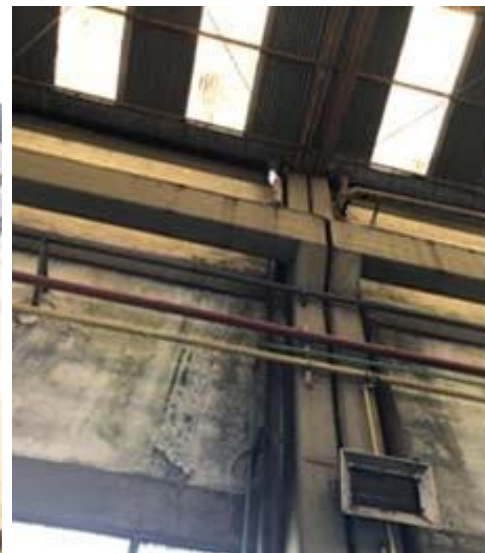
Desprendimiento de Material en Viga Carril
